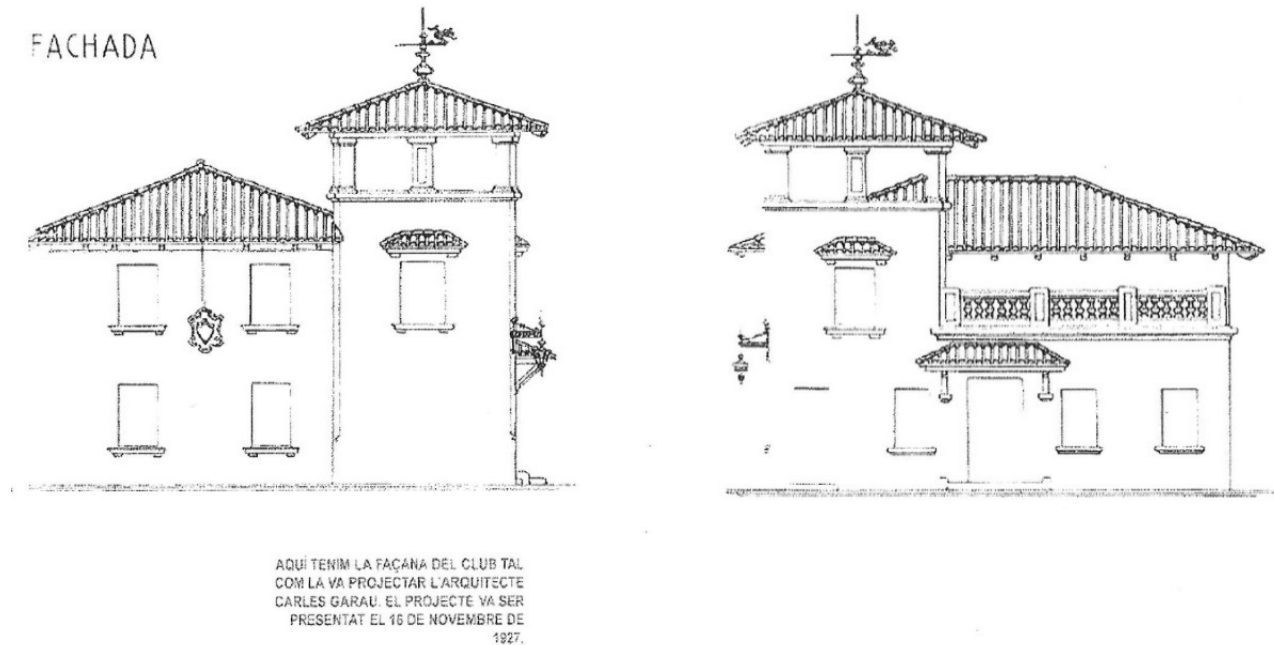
Alzados Norte y Oeste del proyecto de Carles Garau, 1927.
